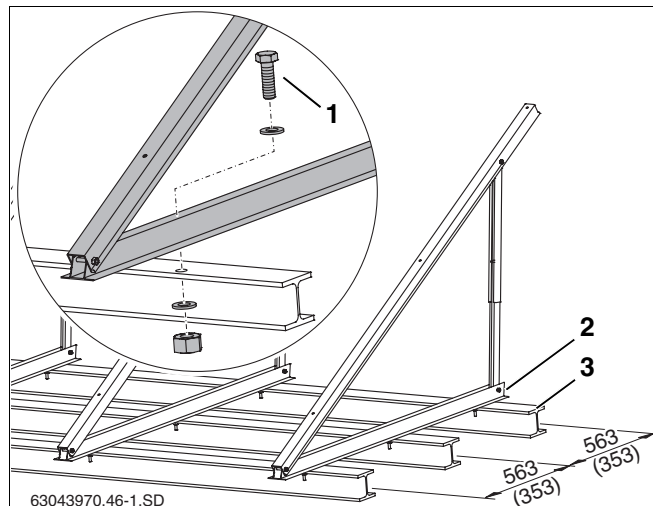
Suportii acoperiș plan cu piesă T dublă, mărimi în mm (valoarea din paranteză = execuția orizontală)
